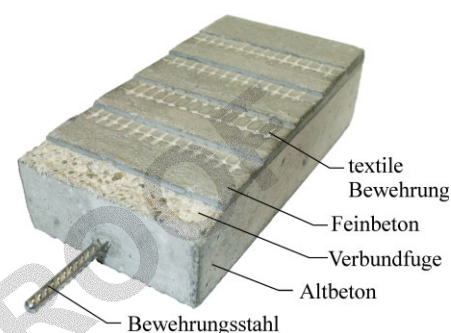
Prinzip einer Verstärkung mit textilbewehrtem Beton
